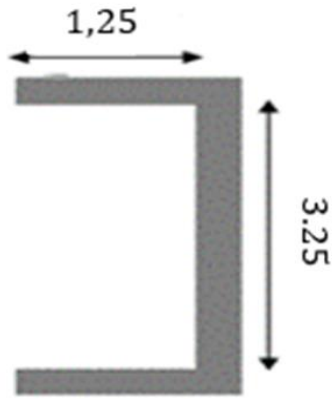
Schéma de ferrailage de la dalle sur un seul appuiIII-2-3- Dalle sur trois appuis :
